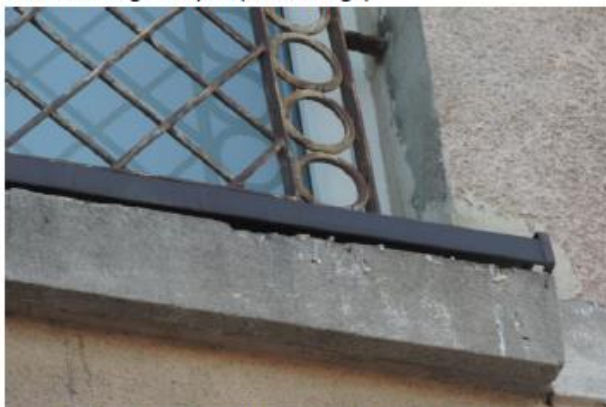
Gniazdo wróbla znalezione na elewacji zachodniej głównego budynku (patrz. też Foto 4).
